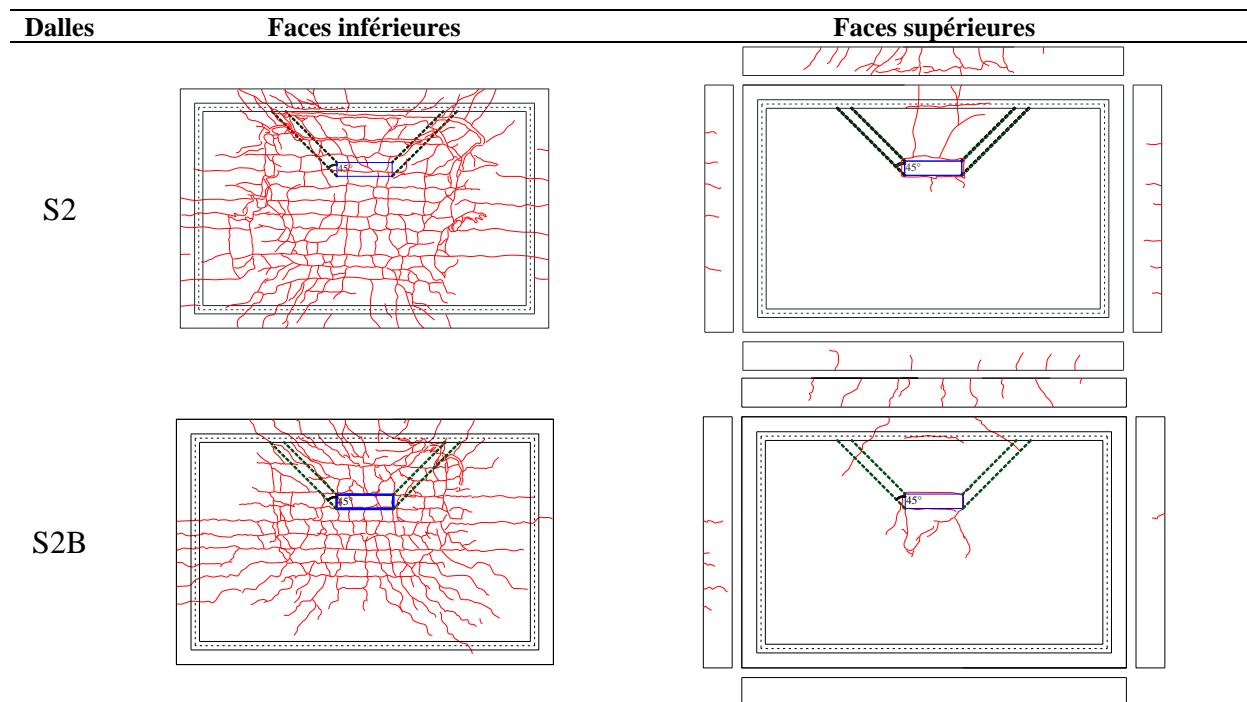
Schémas de fissuration des dalles S2 et S2B: Série V
